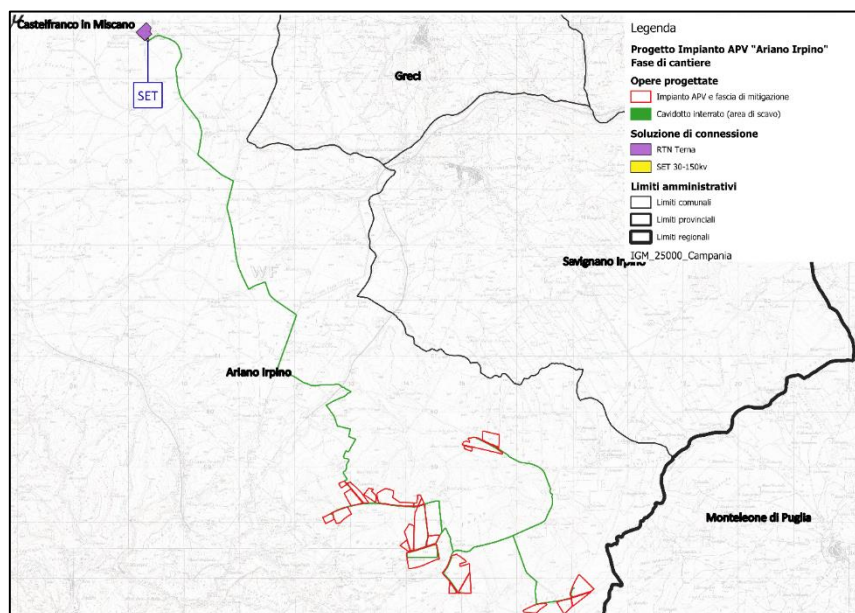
Planimetria delle aree occupate in fase di cantiere.
